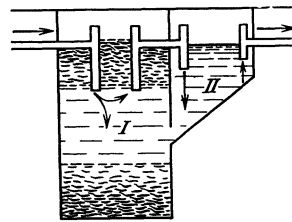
Faulkammeranlage mit gemeinsamem Schlammfoulraum.
